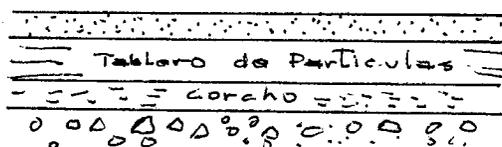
Losetas vinílicas sobre tablero de partículas independizado del soporte por una plancha de corcho.
